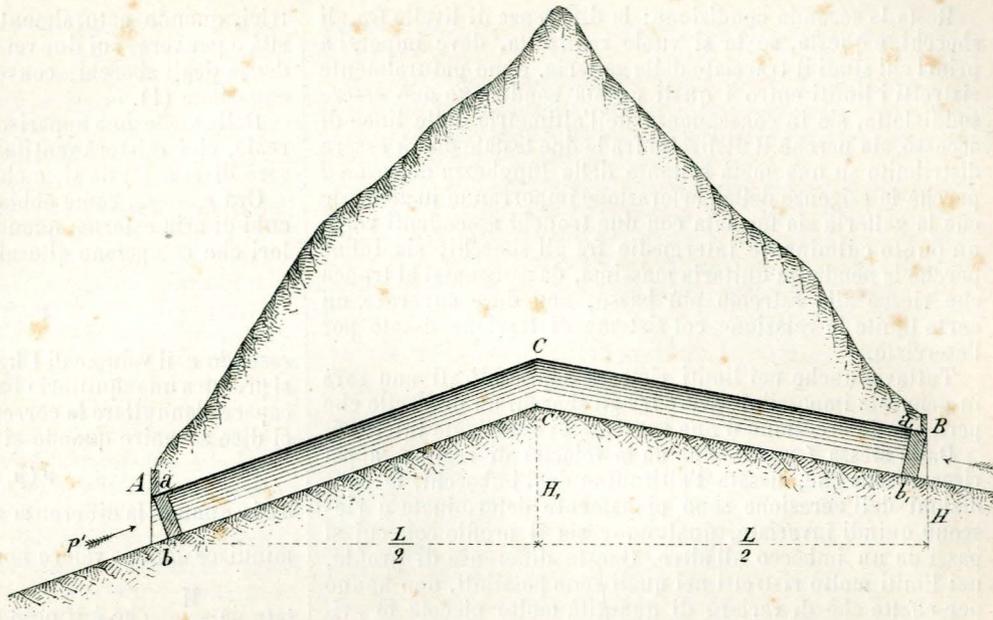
Sezione longitudinale schematica di una galleria sotto ad una montagna.
